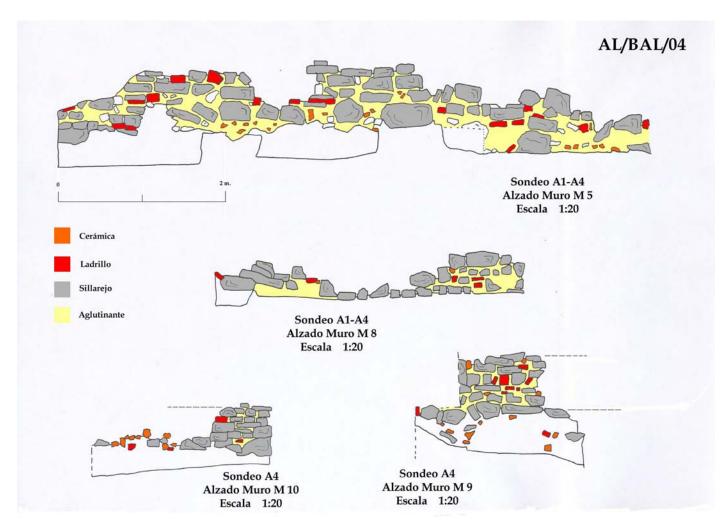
Alzados de los muros M 8 (Fase I), M 5, M 9 y M 10 (Fase IIa).
